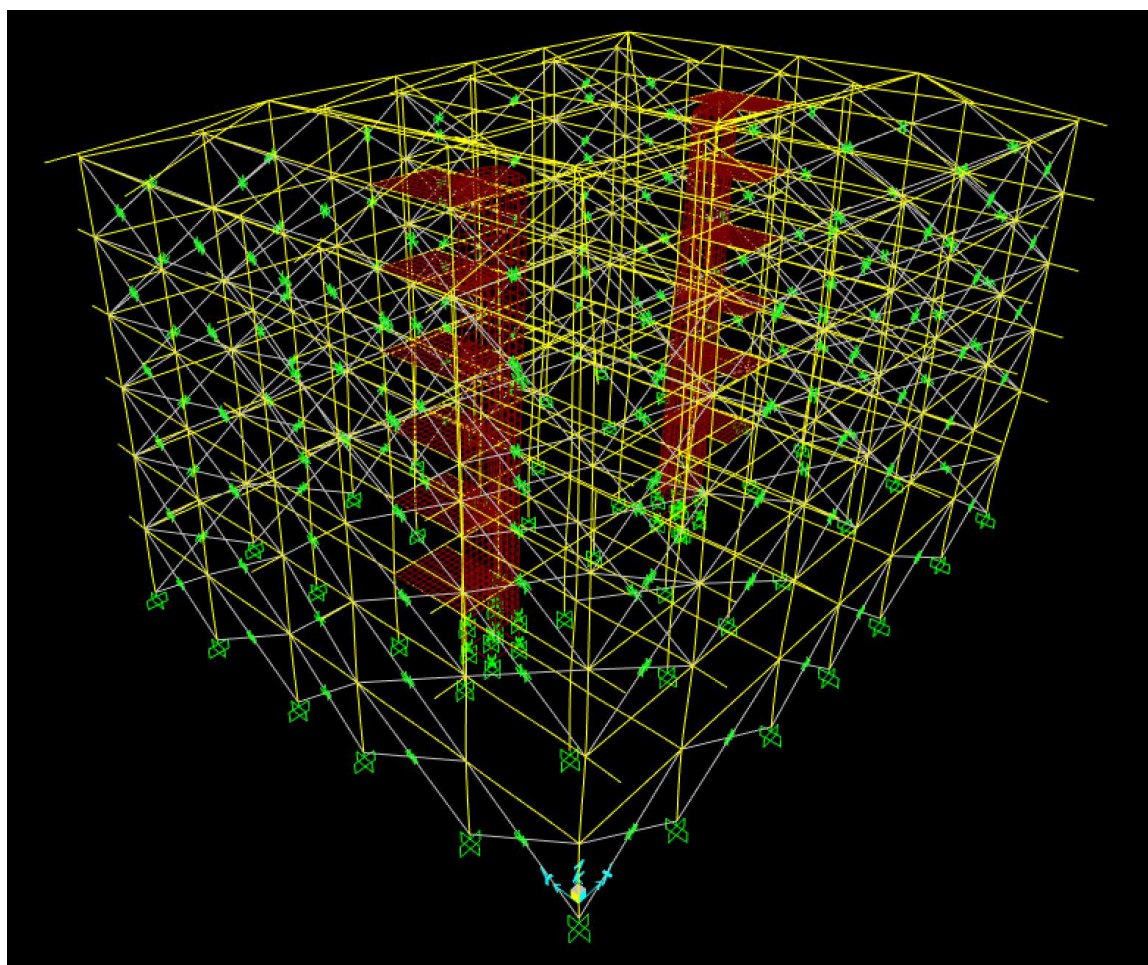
Vista tridimensionale del modello SAP2000 con tamponature.
